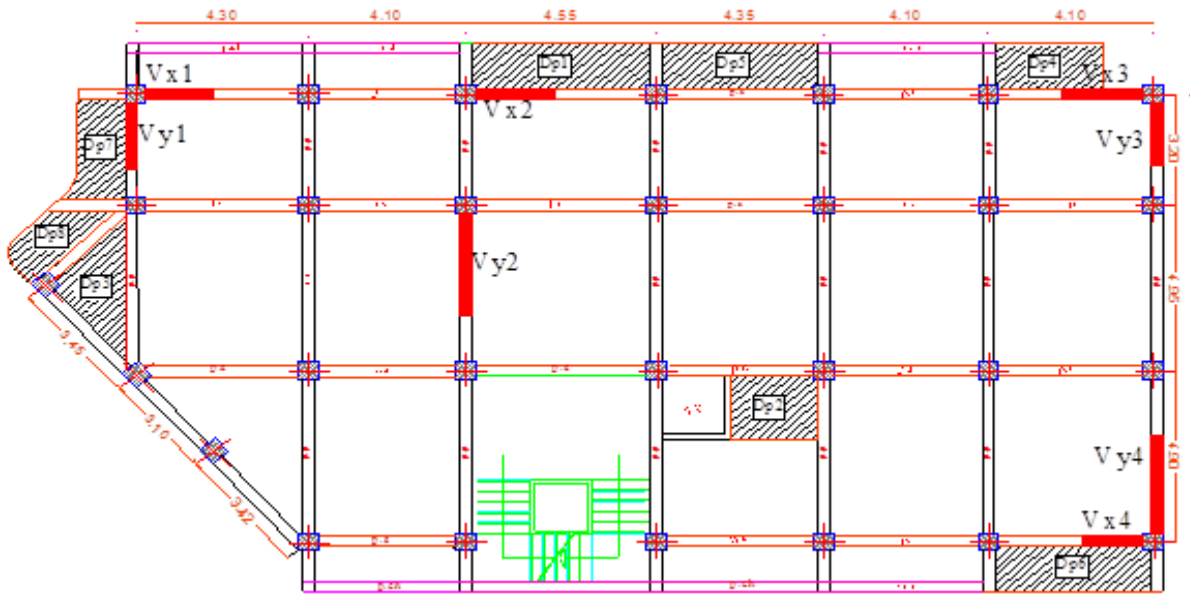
Vu en plan de la disposition des voiles de contreventement.
